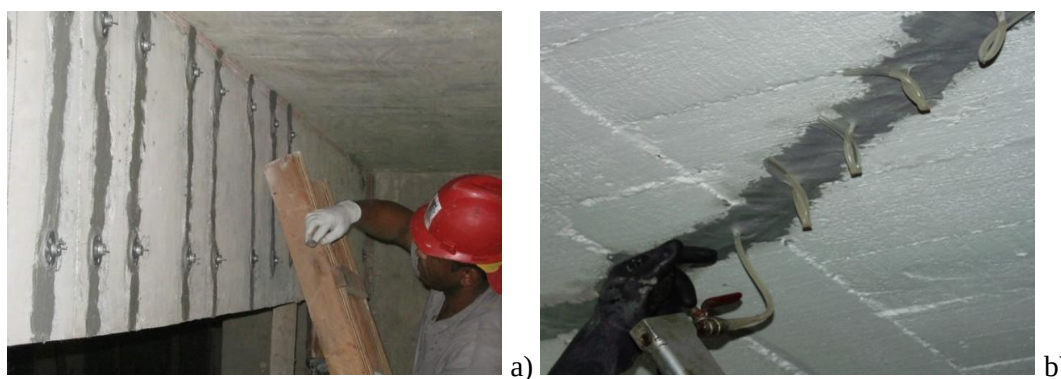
Injeção de resinas epóxi em fendas de elementos estruturais (STAP, 2024): a) viga; b) laje.
